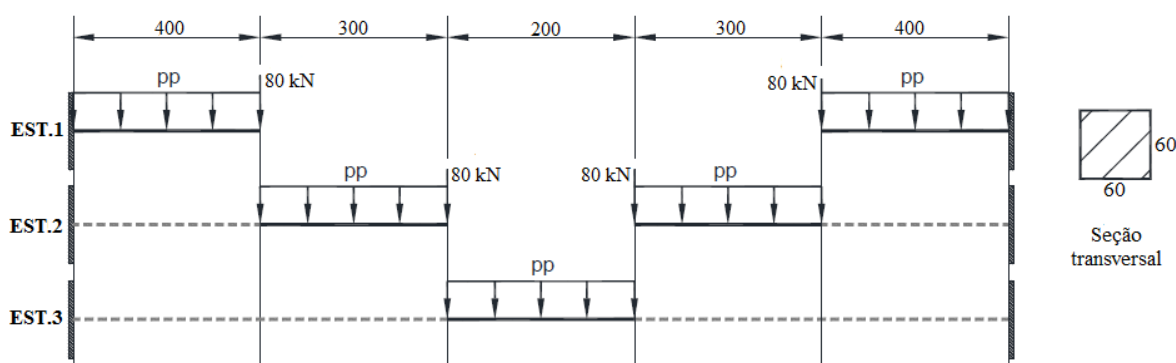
Características geométricas e de execução da viga bi engastada (medidas em cm) – Fonte: Adaptado Santos e Ribeiro (2015).
